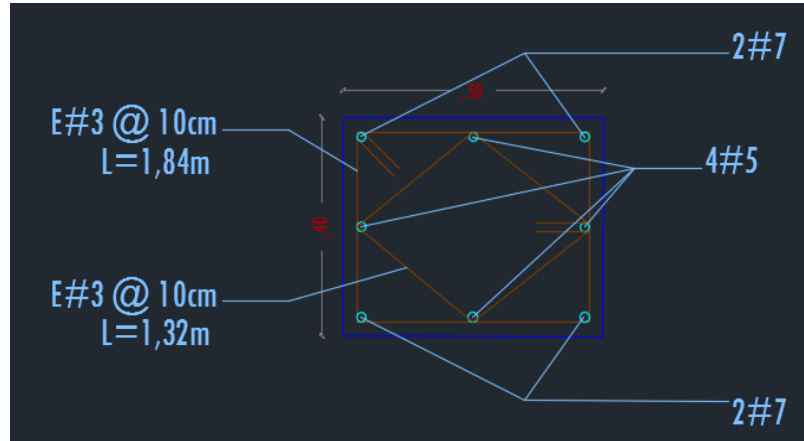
Sección transversal de las columnas del eje 1, 4 y el eje 5 desde el sótano al último piso
